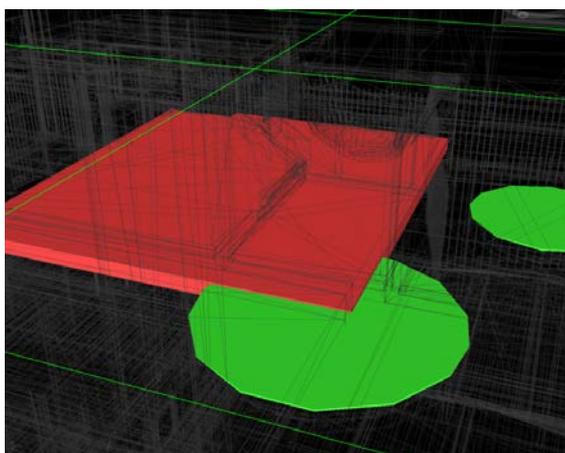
Conflito entre viga (vermelho) e laje (verde)
